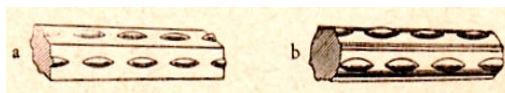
Barras Johnson (PIANCA, 1955, p. 393).
